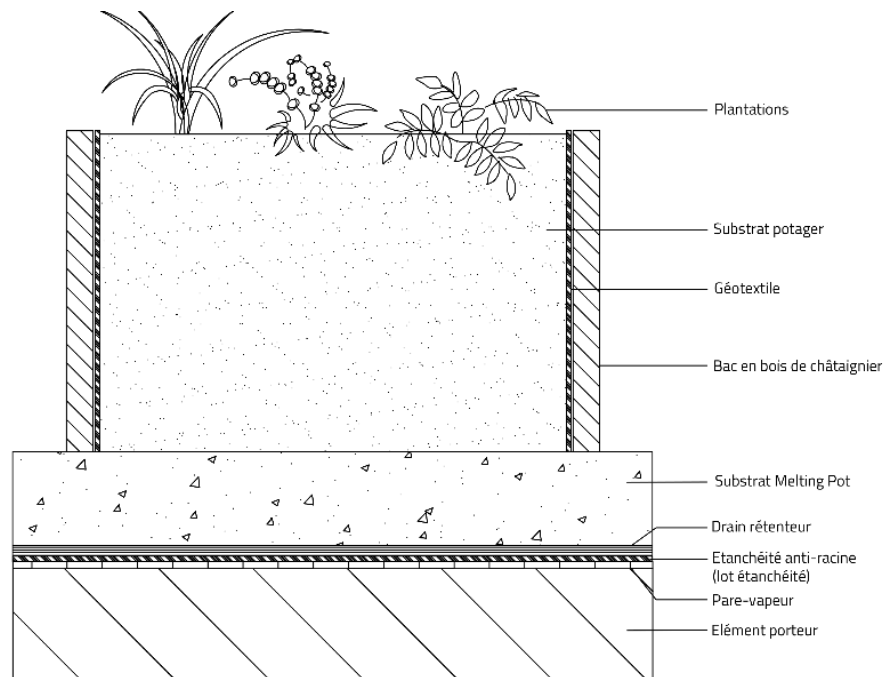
Coupe de principe d'un bac potager sur toiture végétalisée, 2020, Cécile Deslais
